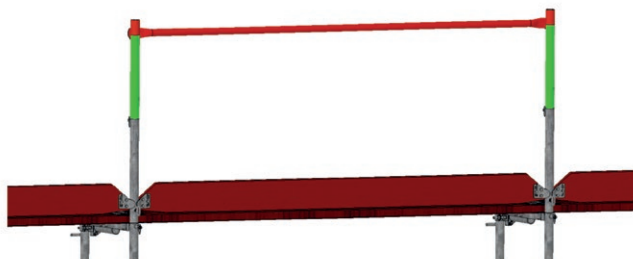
Empfohlene Anschlagpunkte beim oberen Gerüstabschluss
